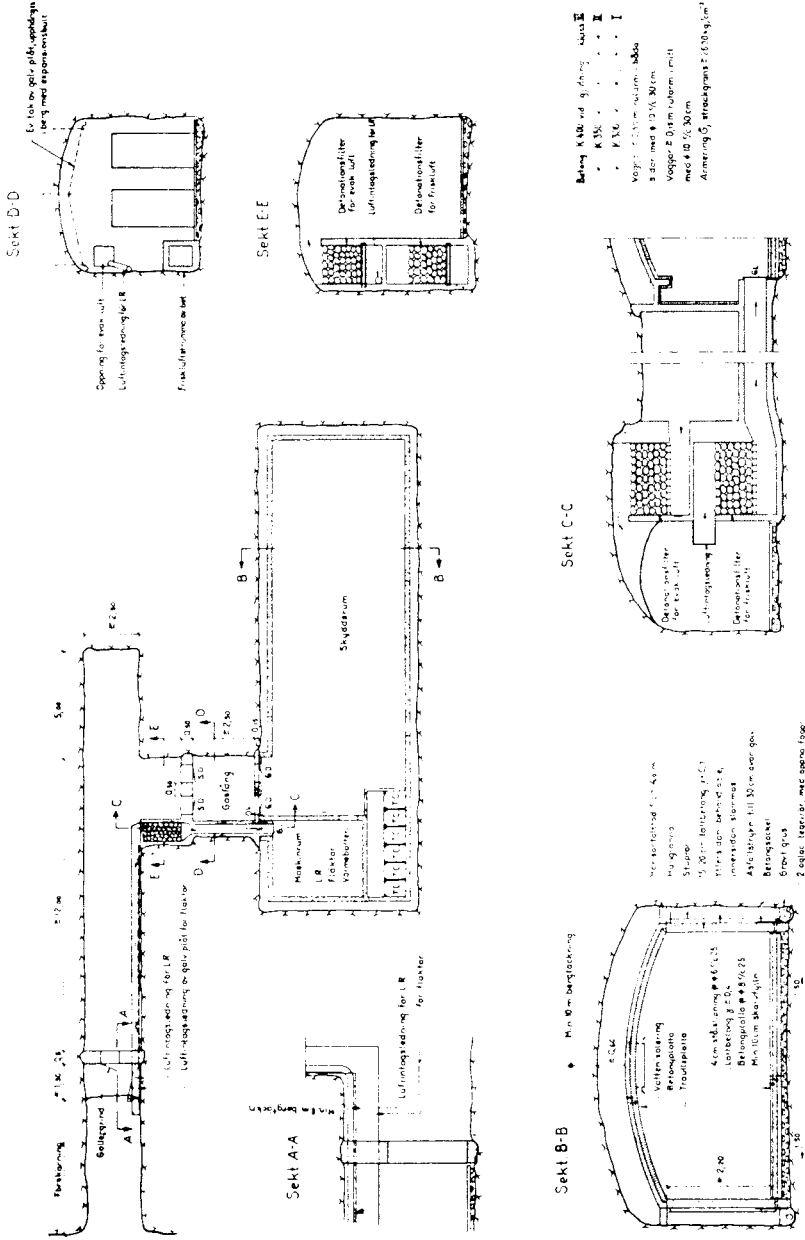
Plan och sektioner till fullträffsäkra skyddsrumsanläggning i berg.
